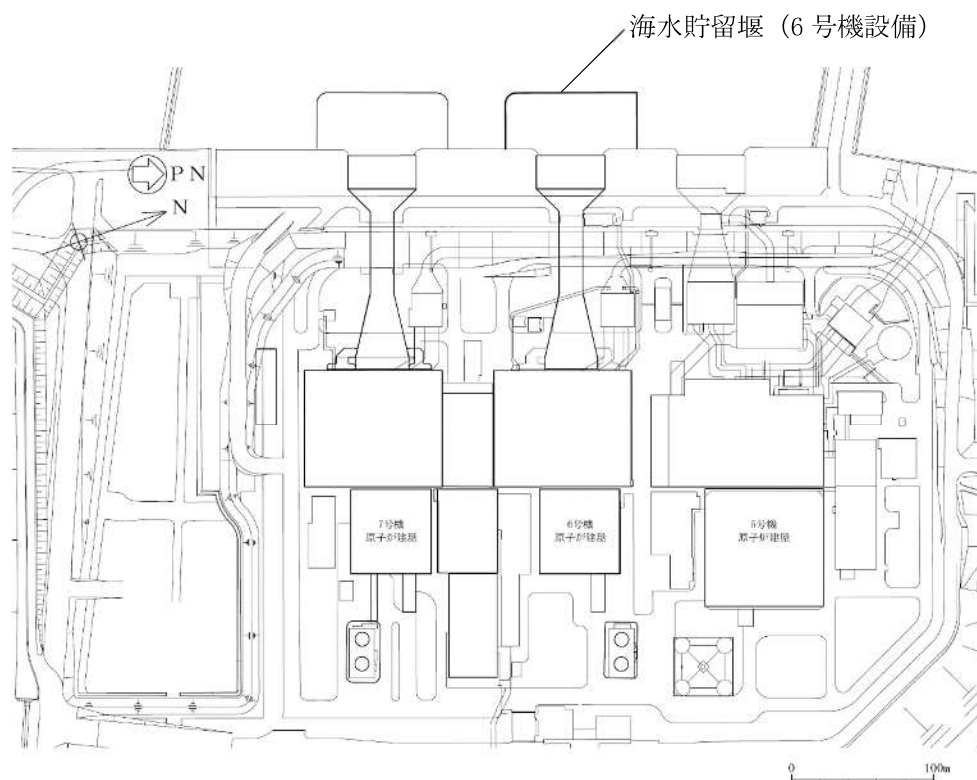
(1) 海水貯留堰（6号機設備）の位置図（全体平面図）
